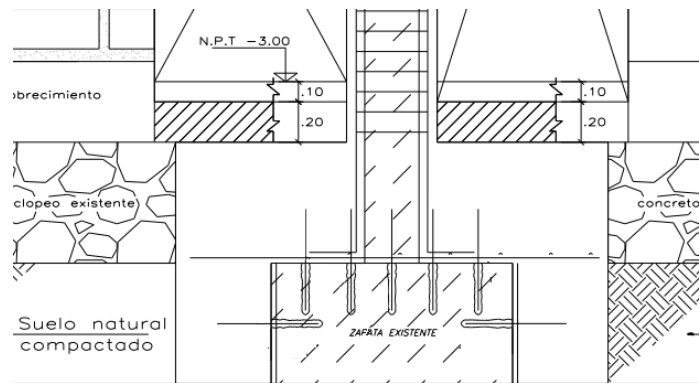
Esquema de reforzamiento de zapatas planteado por Christian Belizario.
